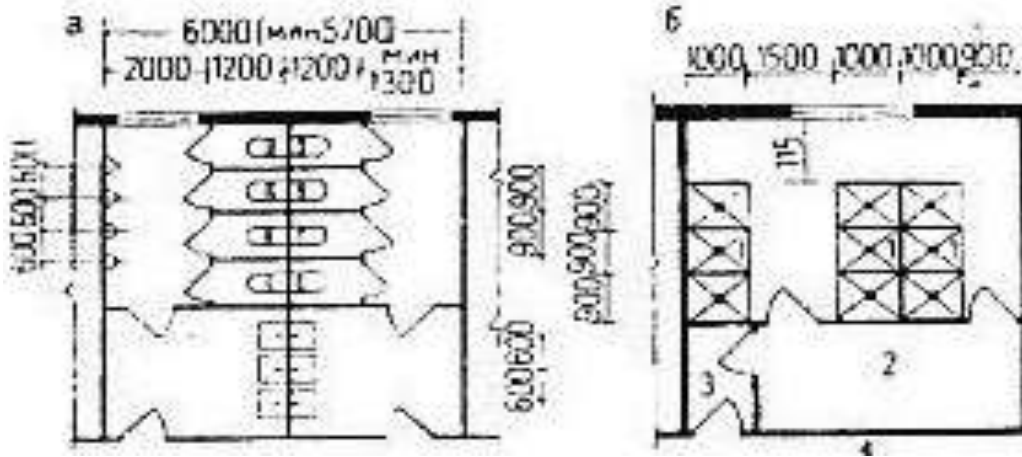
Схема санітарних вузлів громадської будівлі:
